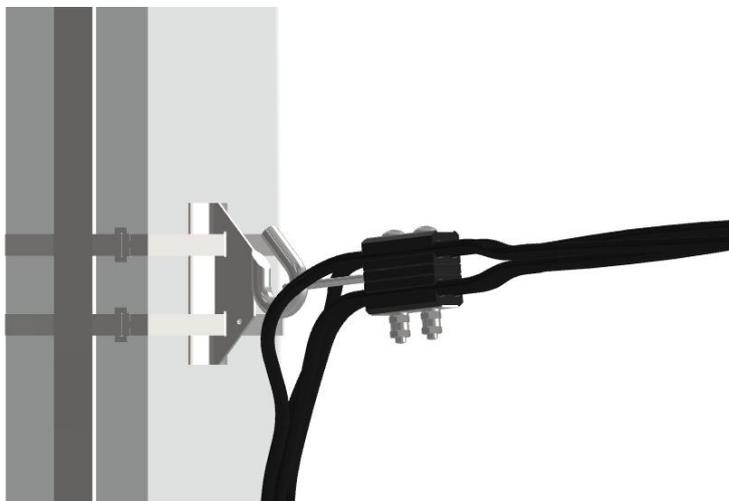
Крепление анкерной арматуры для СИП-2(4)
